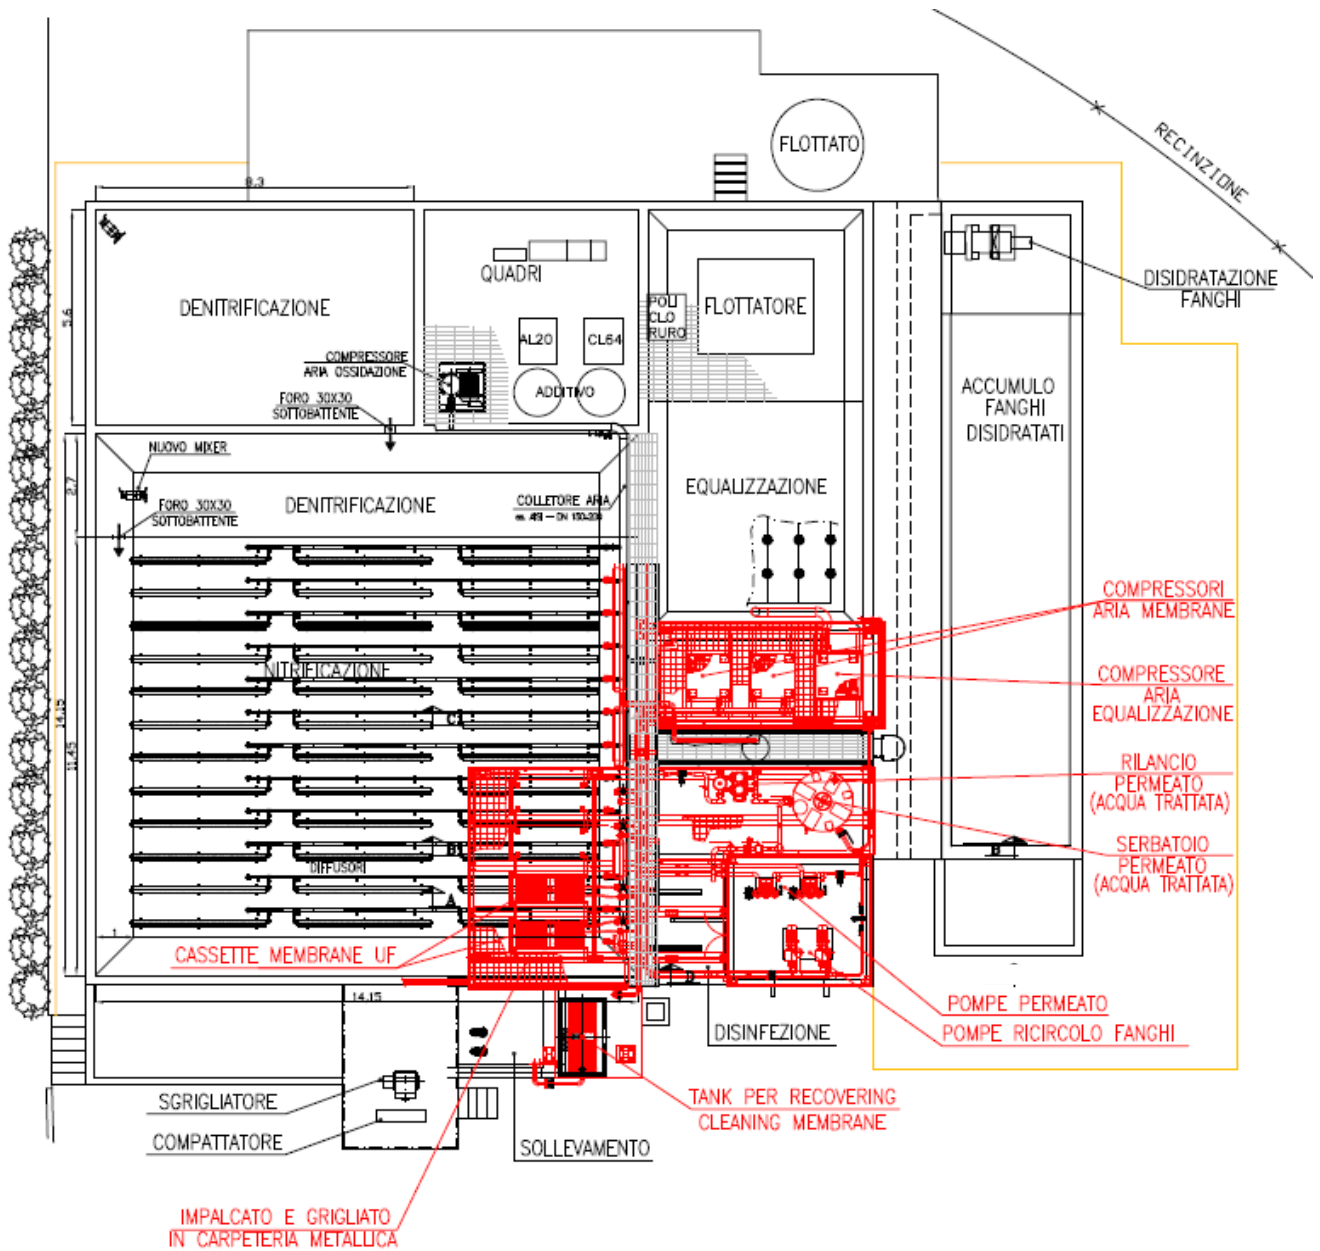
Layout depuratore nella CONFIGURAZIONE DI UPGRADING DI PROGETTO
